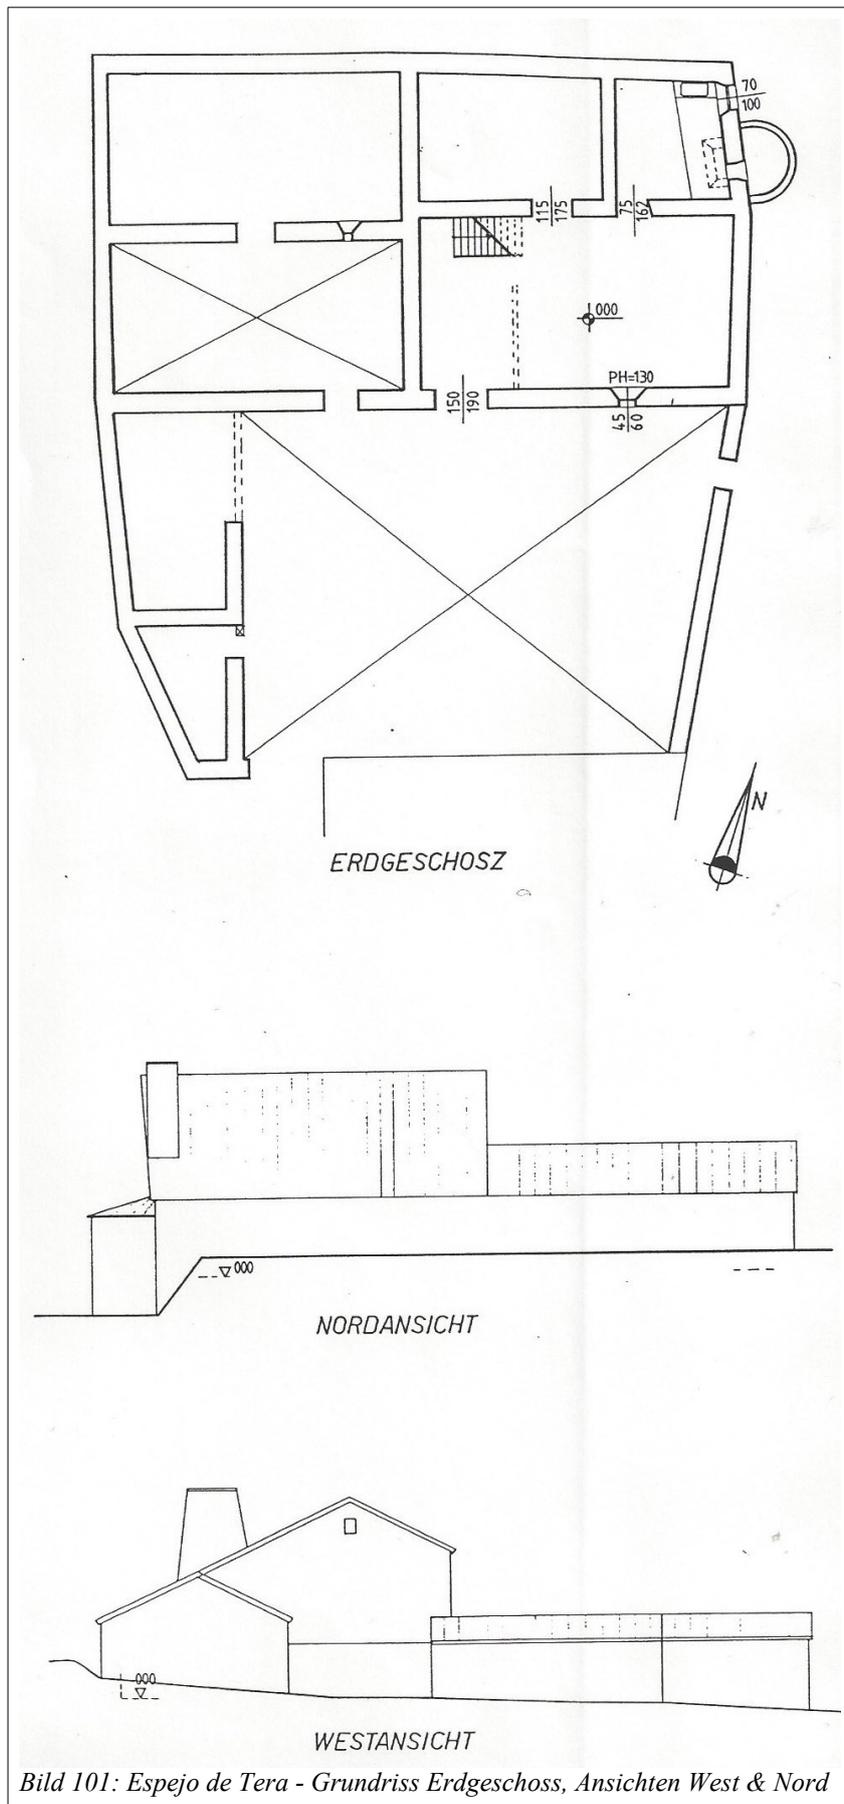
Espejo de Tera - Grundriss Erdgeschoss, Ansichten West & Nord
